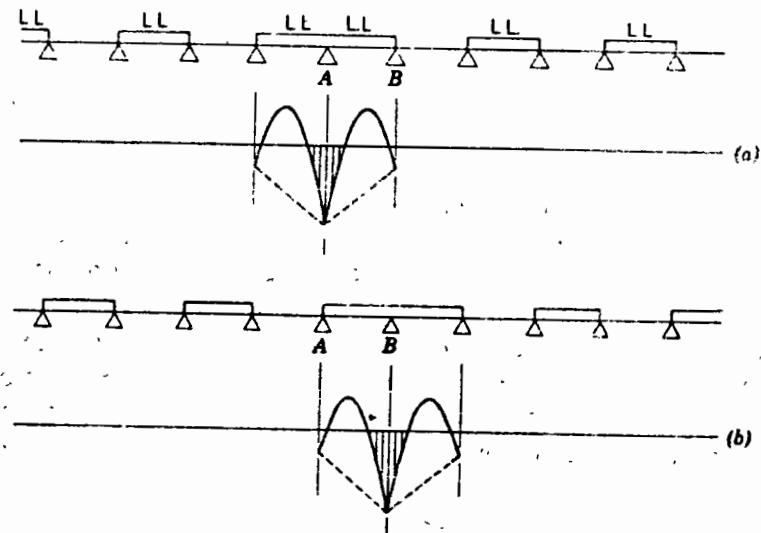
Sistema de cargas para obtener el momento negativo máximo (a) en el apoyo de la izquierda A; (b) en el apoyo de la derecha B
